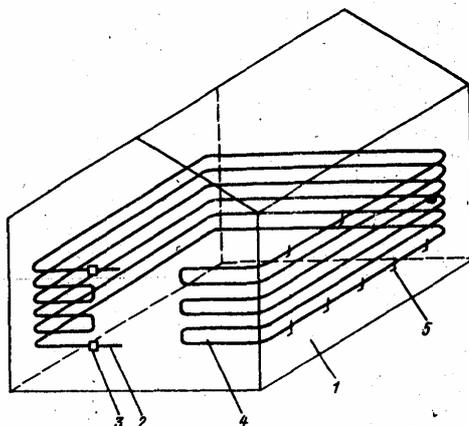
Схема укладки нагревательного провода для обогрева воздуха:
